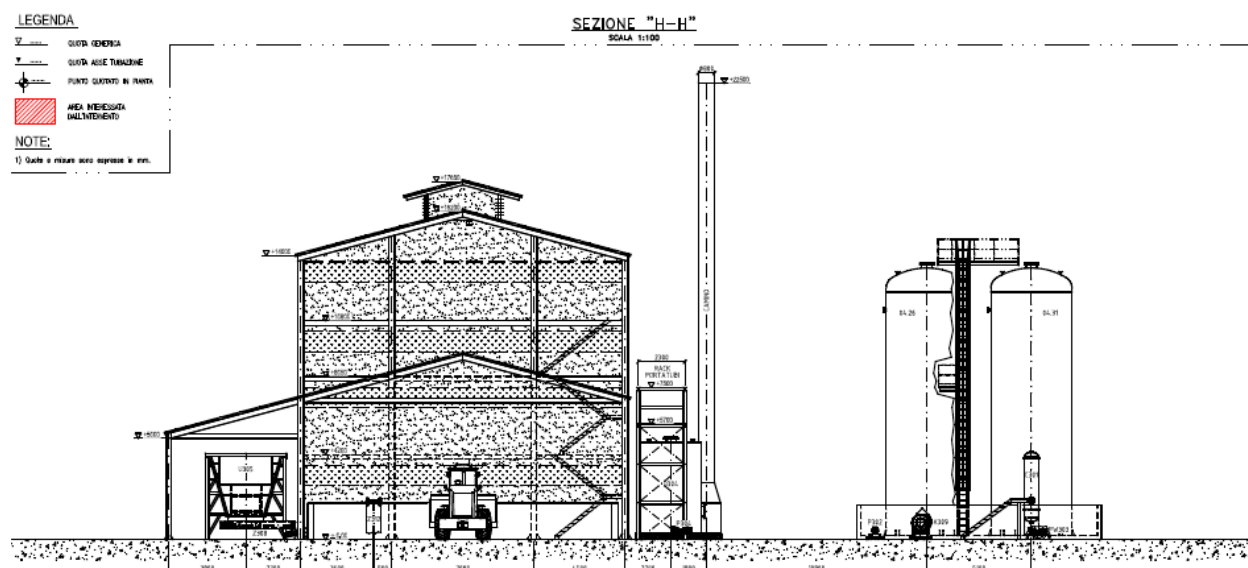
Progetto definitivo delle opere (sezione “H-H”)
